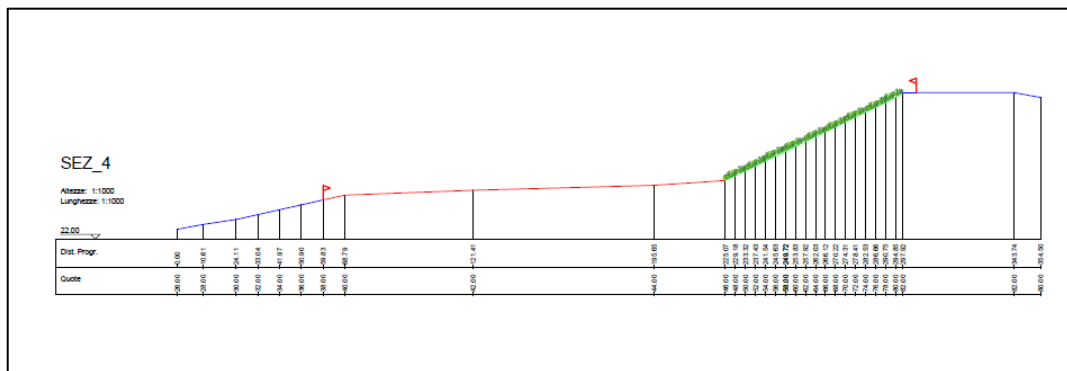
Schema rappresentante sezione di scavo nel terzo stadio di coltivazione
